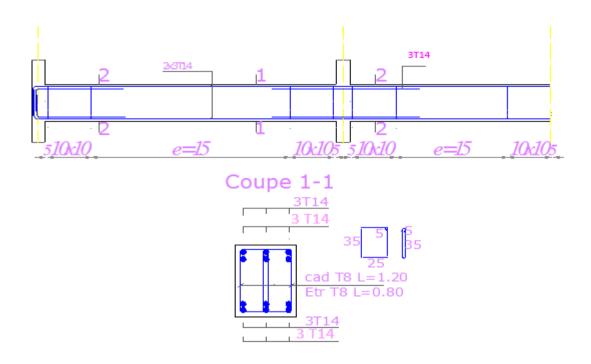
Schéma de ferraillage d'une poutre secondaire —la plus sollicitée-
